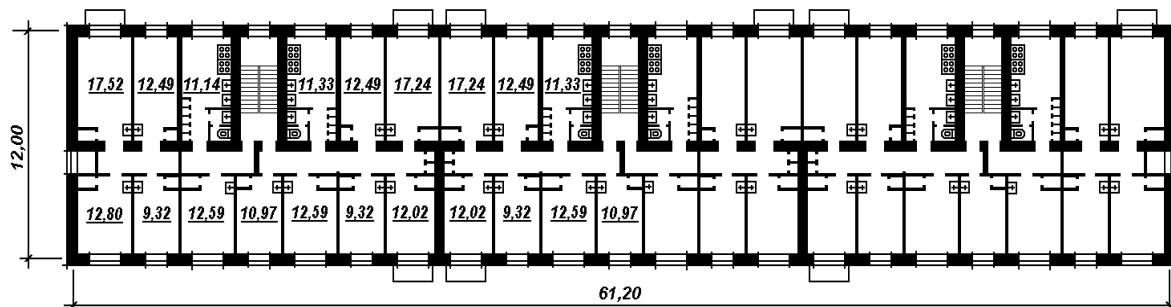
Гипрогор (Москва). Типовая серия 1-446с-3. 1958 г. План типового этажа пятиэтажного жилого дома на 165 квартир
